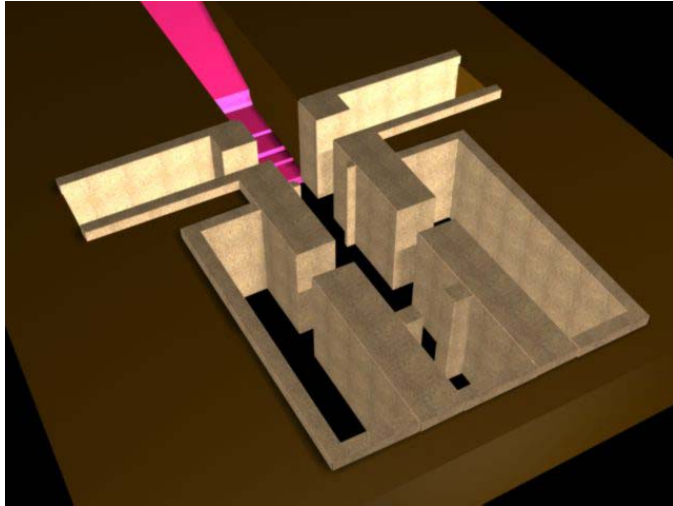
3D-Modell, Testrendering Grundriss
